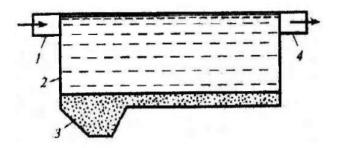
Схема горизонтальной песколовки с прямолинейным движением воды 1 - входной патрубок; 2 - корпус песколовки; 3 - шламосборник (песковый приямок); 4 - выходной патрубок
